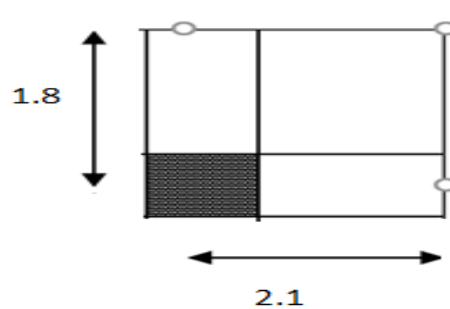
Représentation de la surface reprise par le poteau d'angle.
